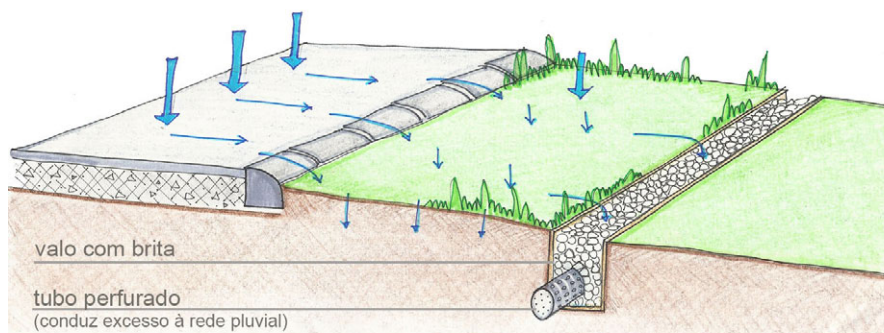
Plano de Infiltração. Ilustração: Bianca Habib, 2010, adaptado de Tucci, 2005.
